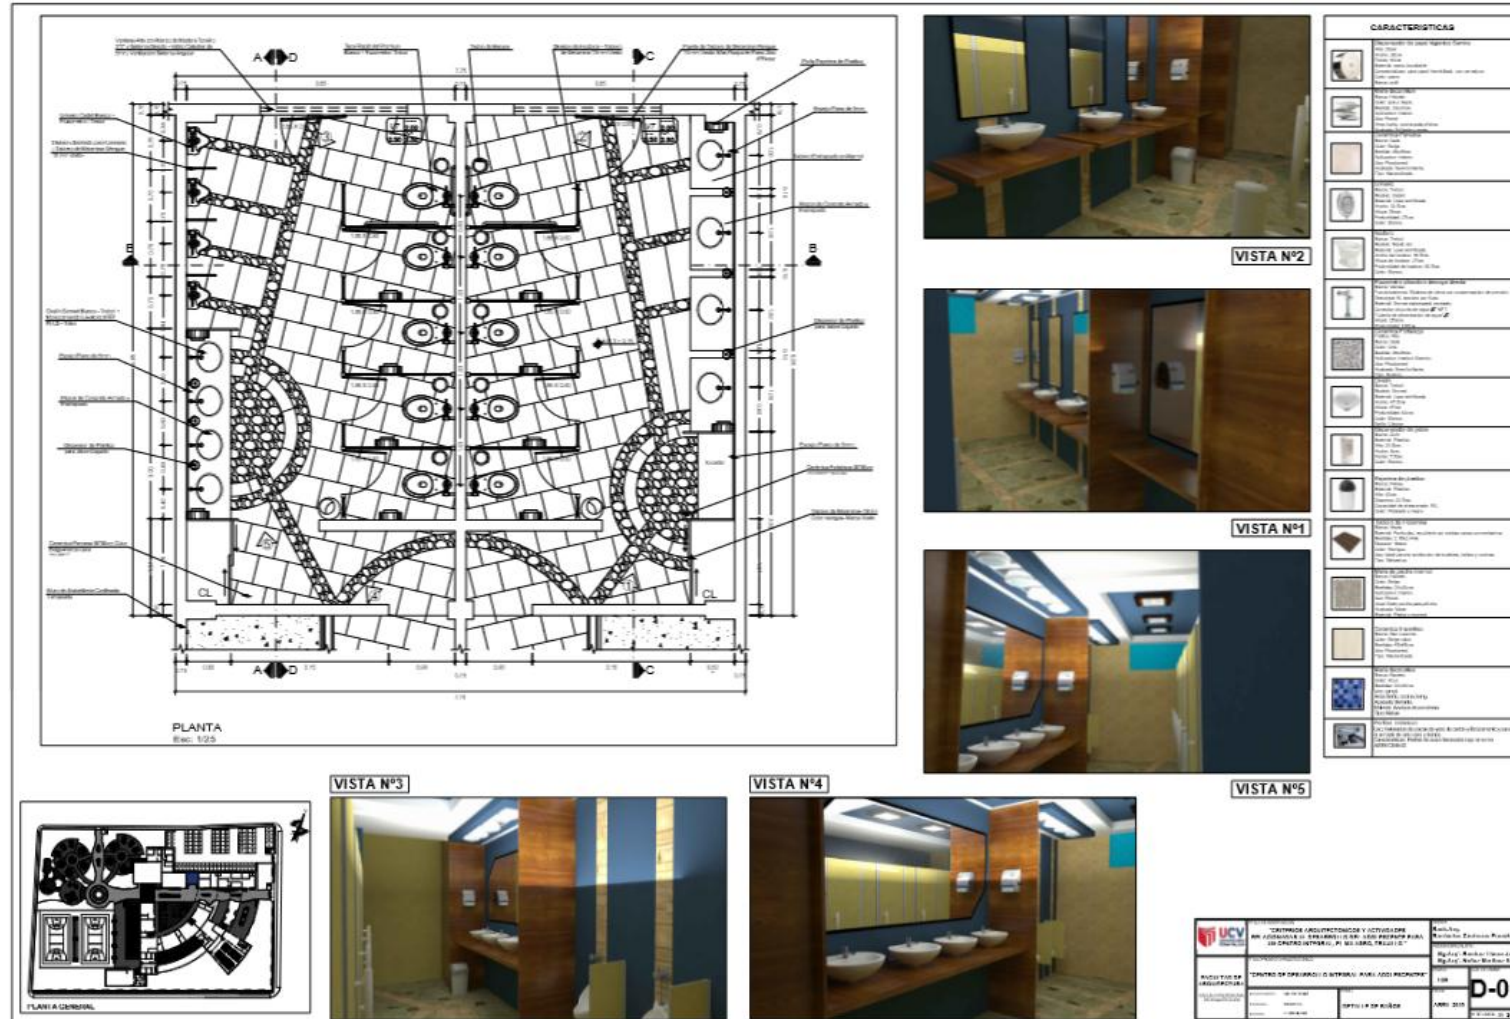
Plano de detalle arquitectónico – servicios higiénicos
